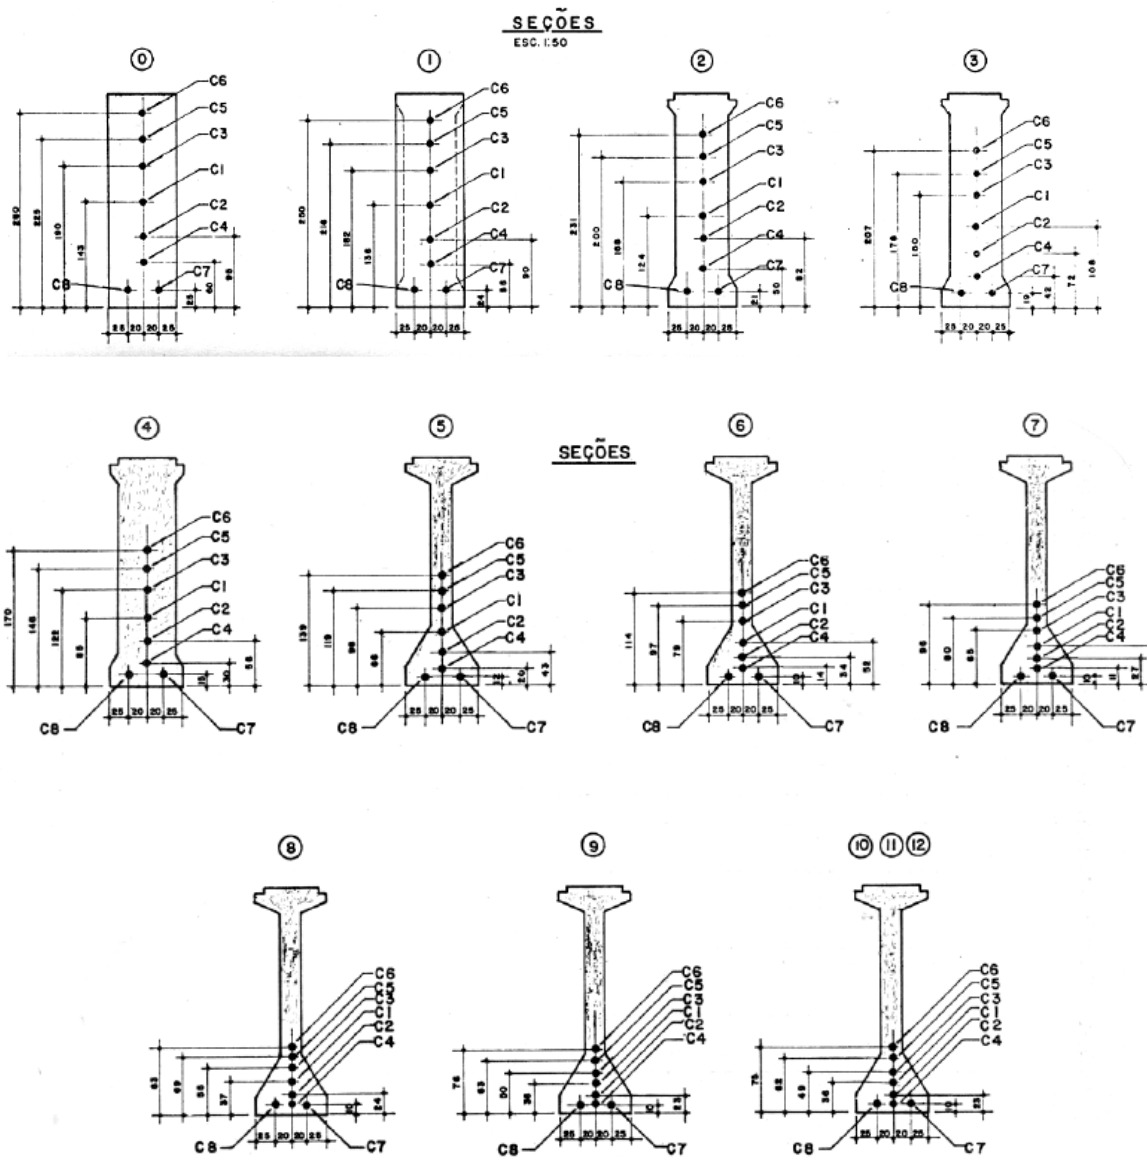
Seções originaisFonte: Revista Estrutura 93 (1980)3.2 PROJETO ATUAL3.2.1 Premissas
